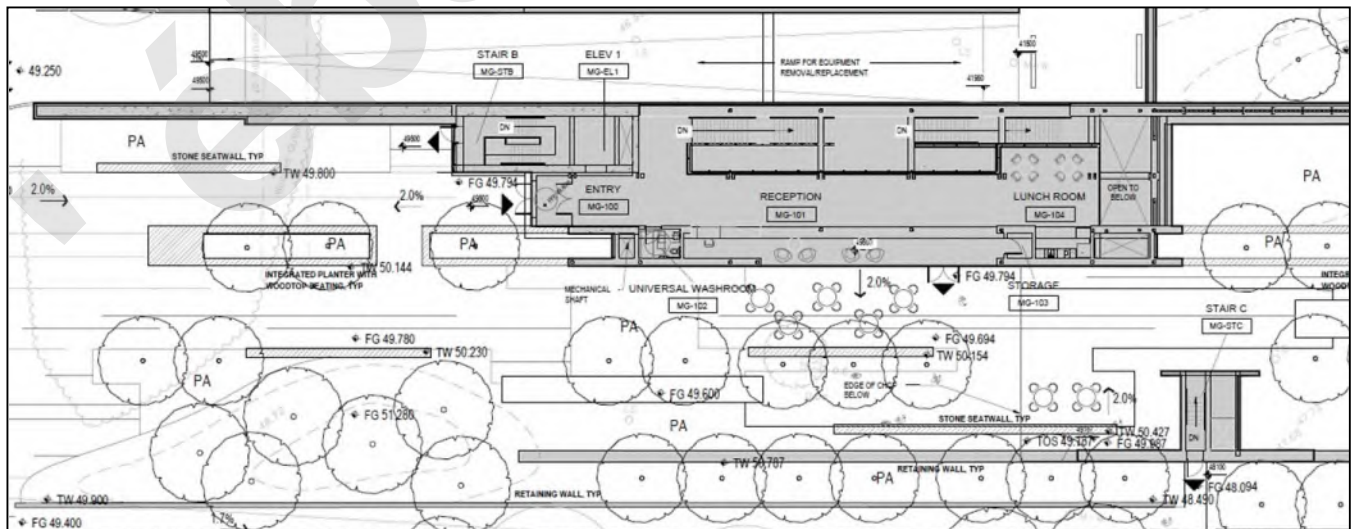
Plan d'aménagement paysager de l'esplanade d'entrée
